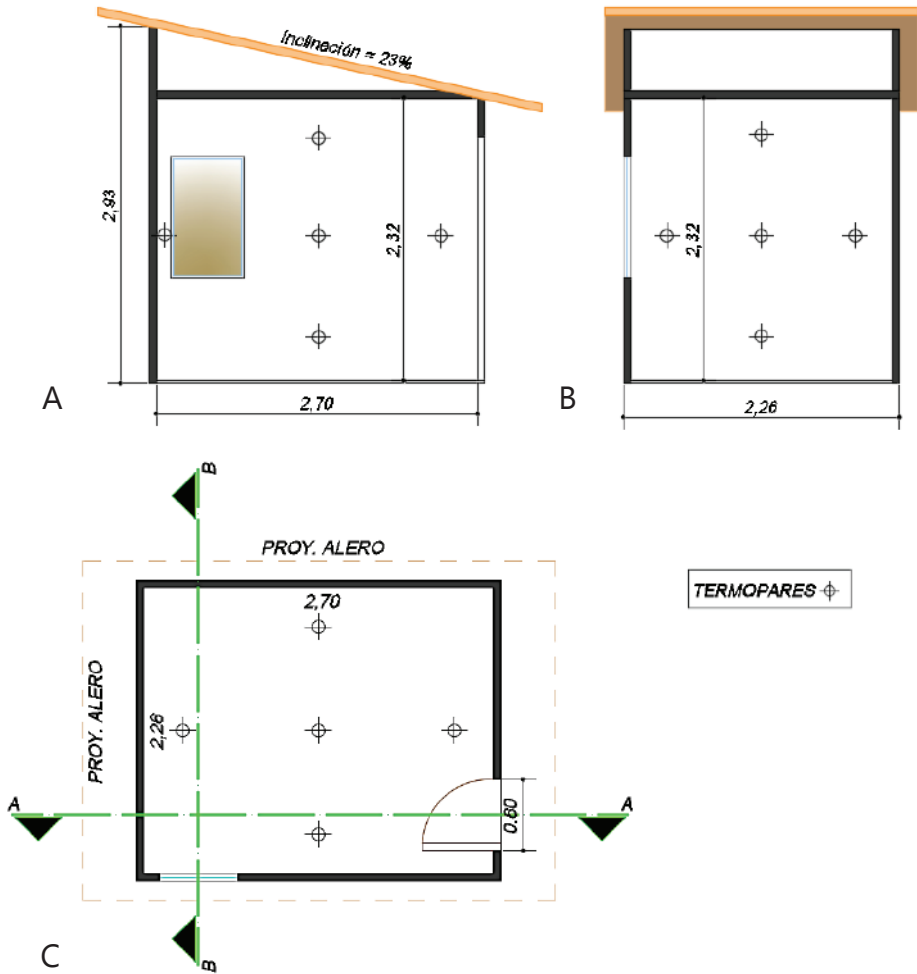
Distribuição dos termopares: (A) Fachadas Oeste, (B) Fachadas Norte e (C) Coberturas. Fonte: Gallardo (2017)⁴³.
